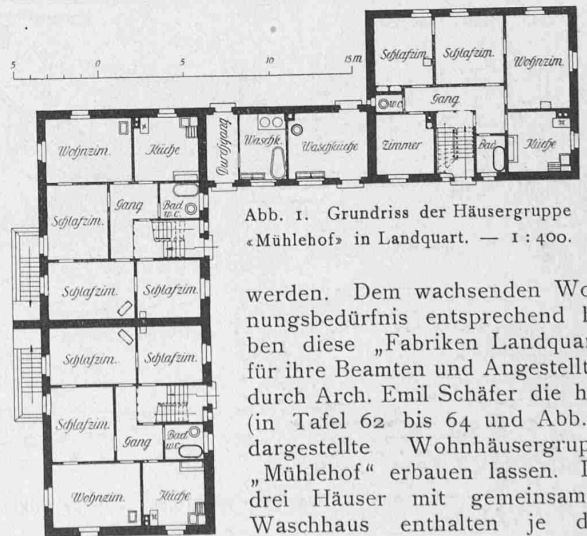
Grundriss der Häusergruppe „Mühlehof“ in Landquart. — 1 : 400.
